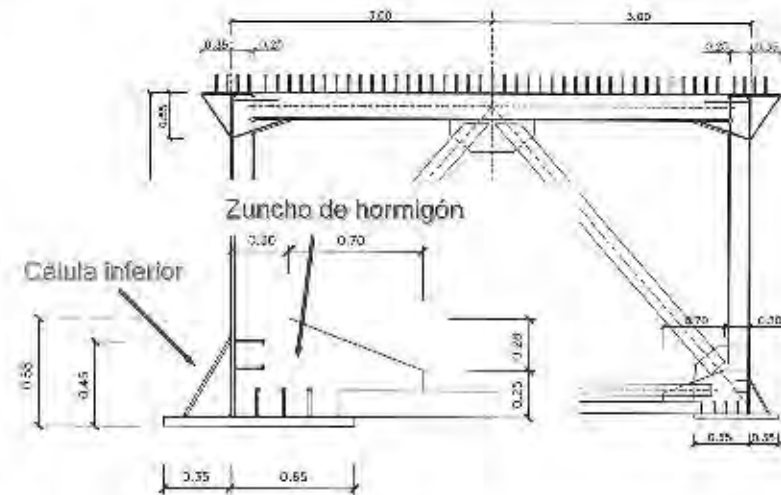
Sección transversal del viaducto sobre el Arroyo de las Piedras. Detalle de nervio inferior de rigidez.
